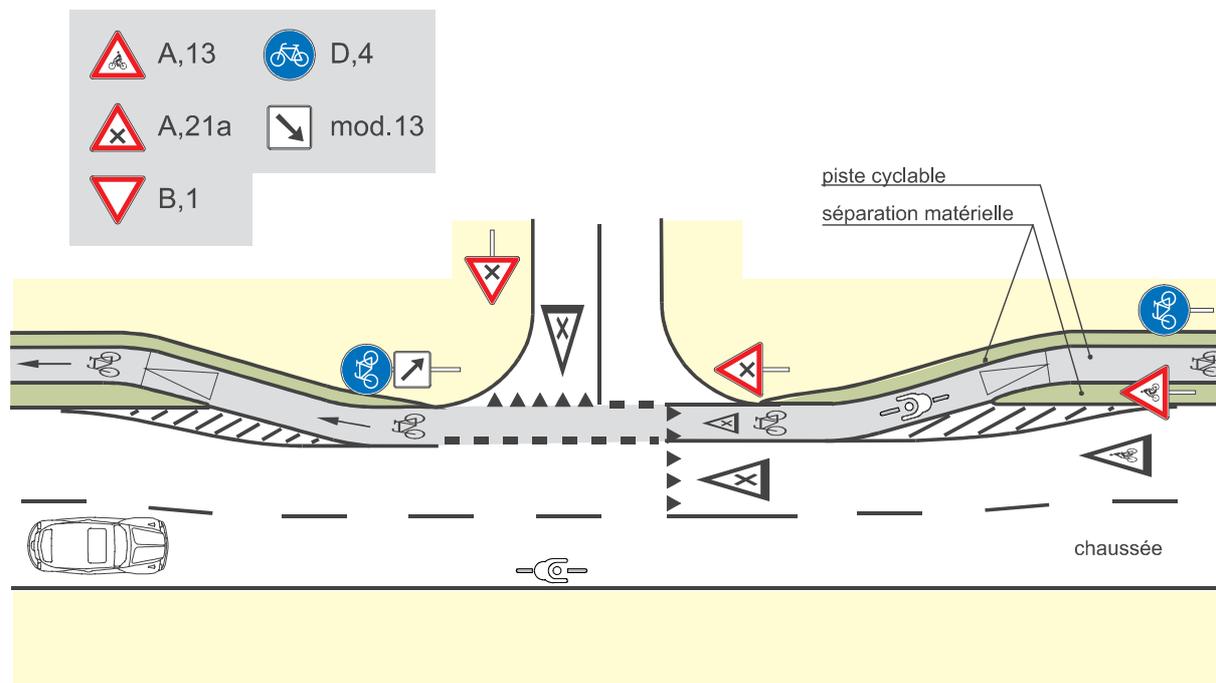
piste cyclable débouchant dans la chaussée à l'approche d'une intersection
